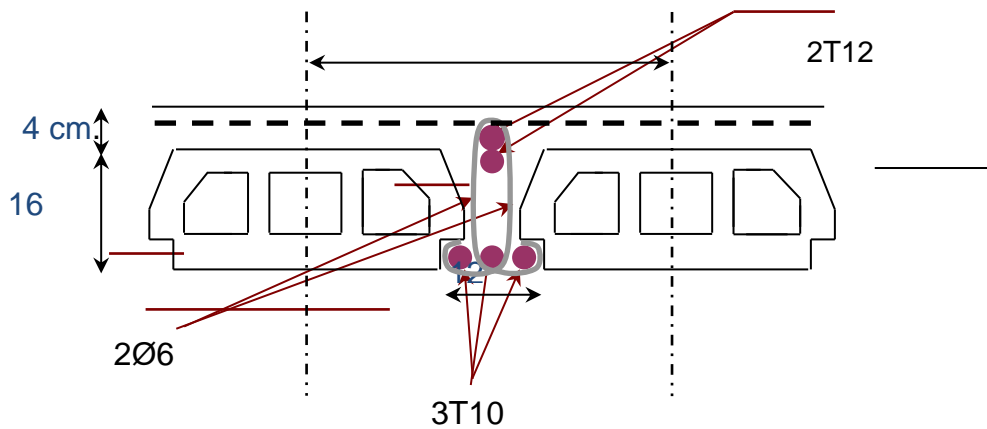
ferrailage de poutrelle au RDC et étage courant
